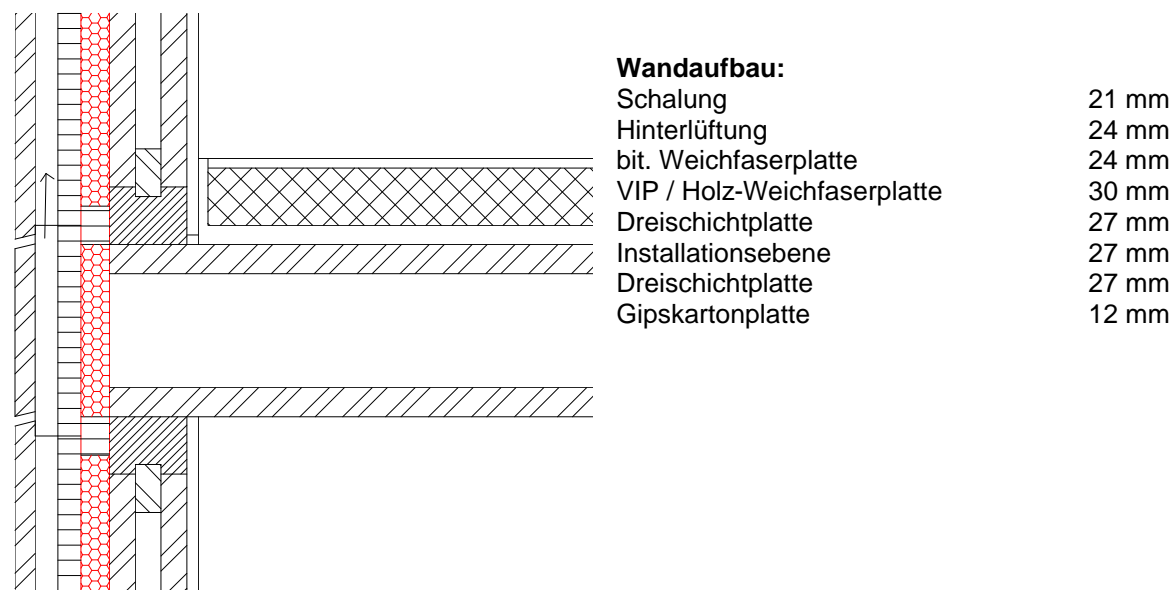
Detail Holzelementbau mit VIP. Querschnitt durch das Deckenauflager.
